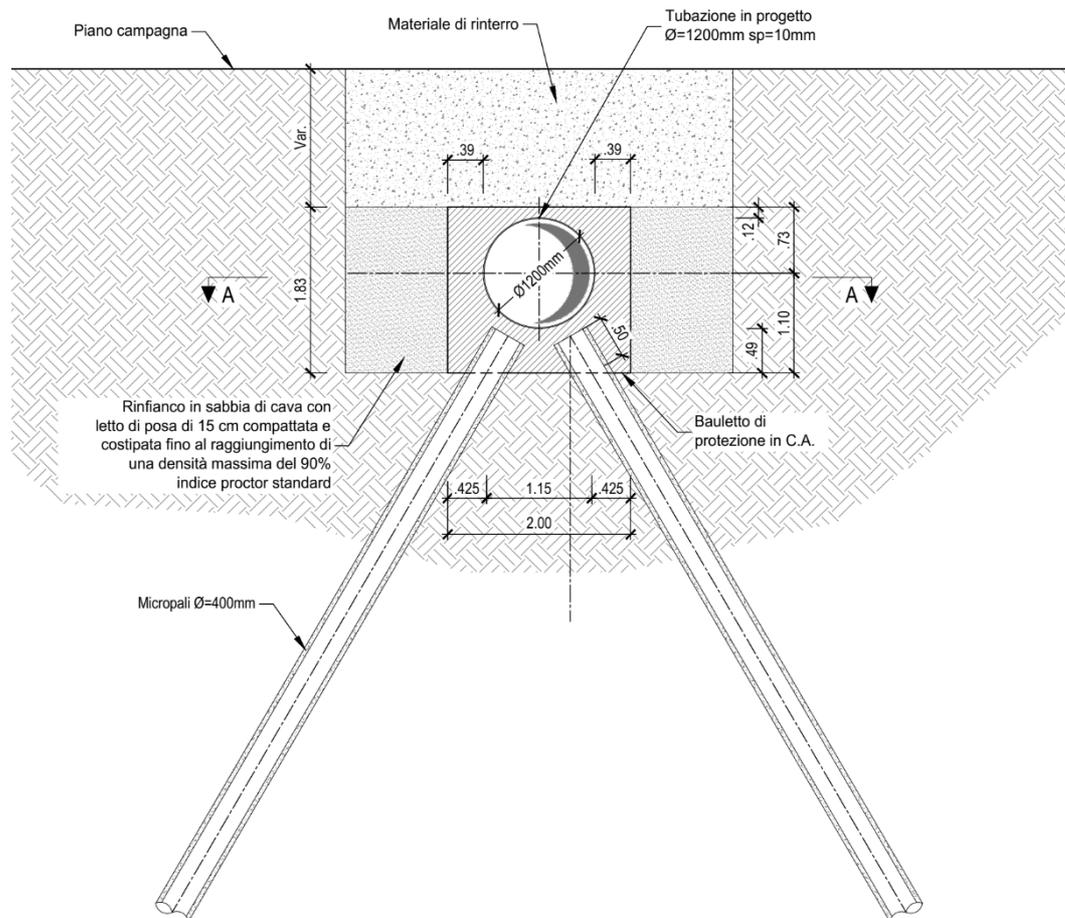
Consolidamenti della condotta in zona La Ciaccia (ancoraggi) - Schema tipologico.
